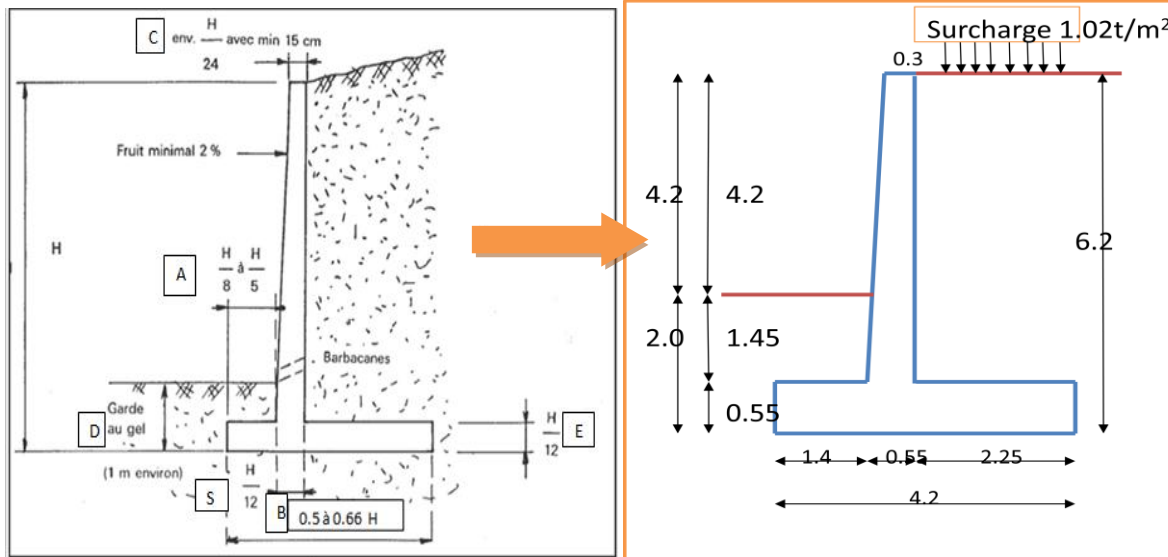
pré-dimensionnement d'un mur de soutènement
